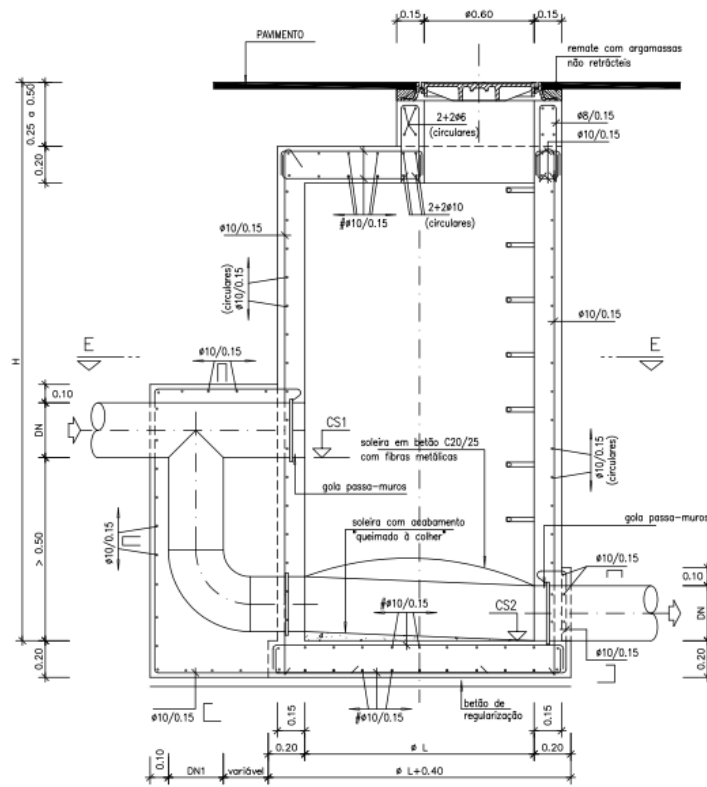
Pormenor construtivo de caixa de visita com queda guiada.
